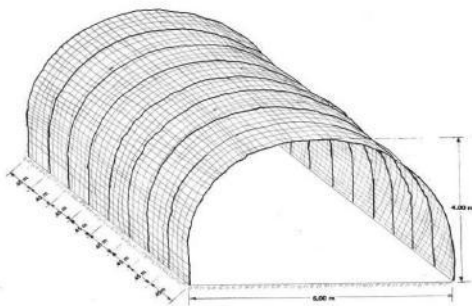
Disposición Isométrica del Refuerzo Metálico: Mallado alambre N° 8 de 10cmX10cm(Rojo) y Acero corrugado de construcción  $\phi = 5/8''$ (Azul). Escala: 1/100
